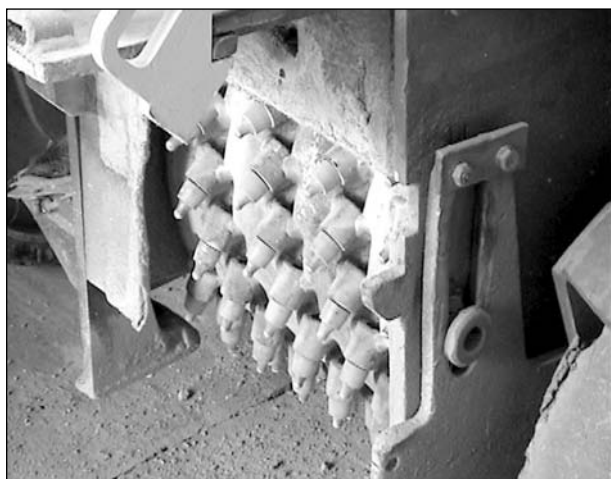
Detail Walzenfräse; Teilansicht Walze mit Meißeln
